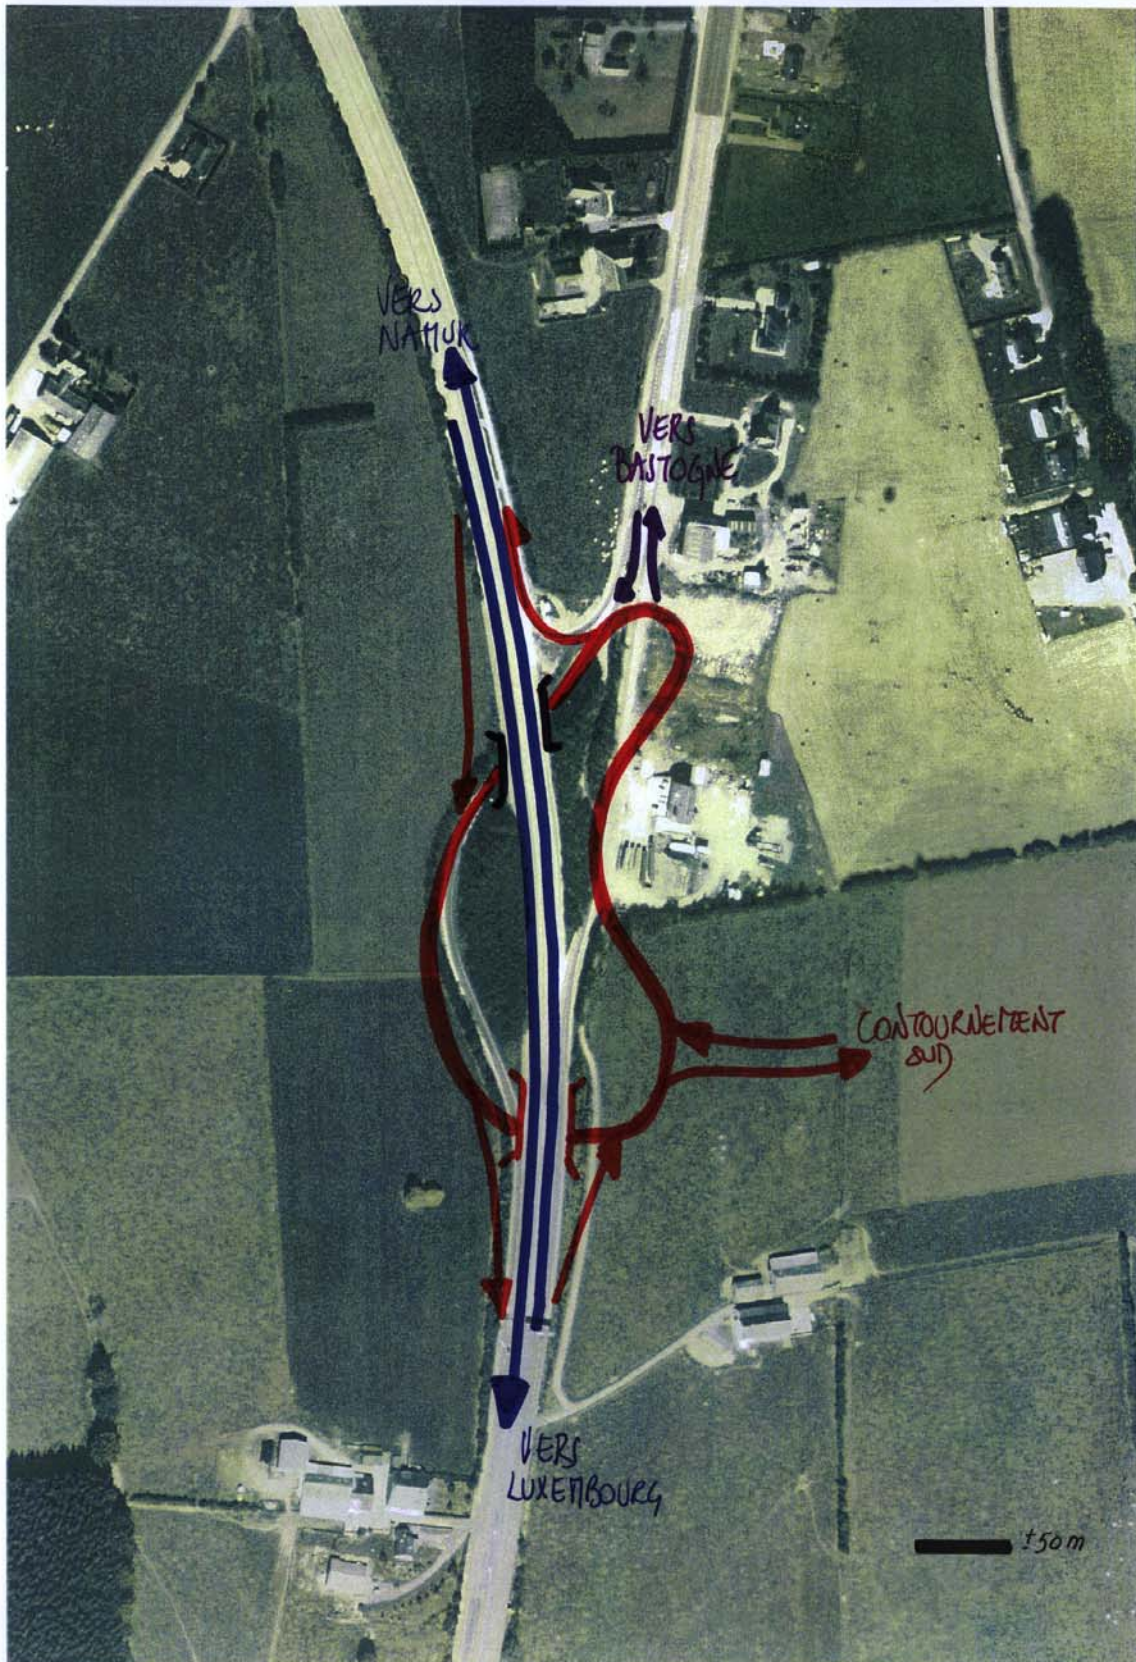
Carrefour RN 4 – route d'Arlon: Variante C
